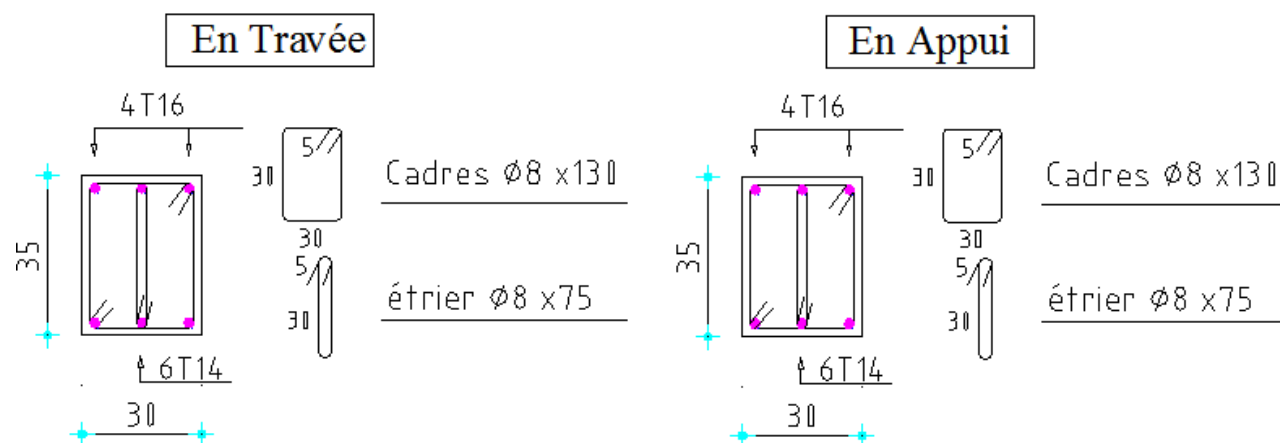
Dessin de ferrailage de la poutre principale
